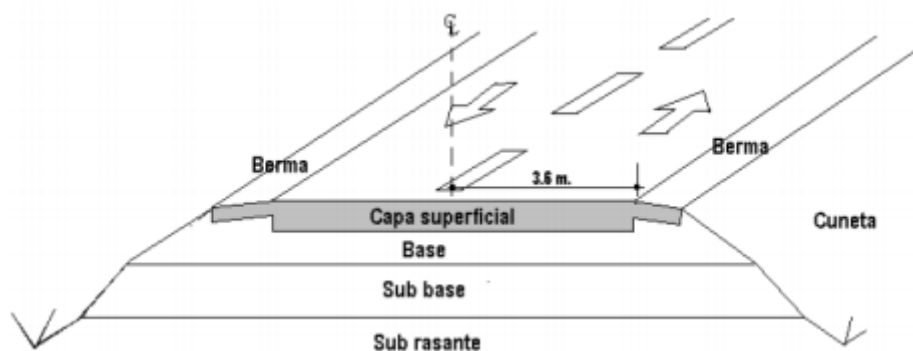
Estructura típica de un pavimento asfáltico (flexible)
